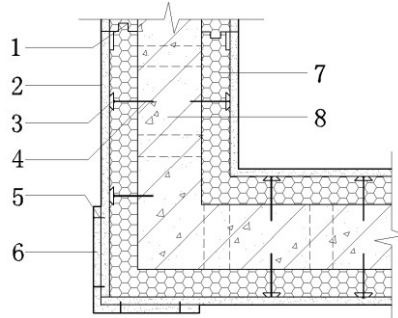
水泥板与墙体阳角连接组合构造（水平剖面）
